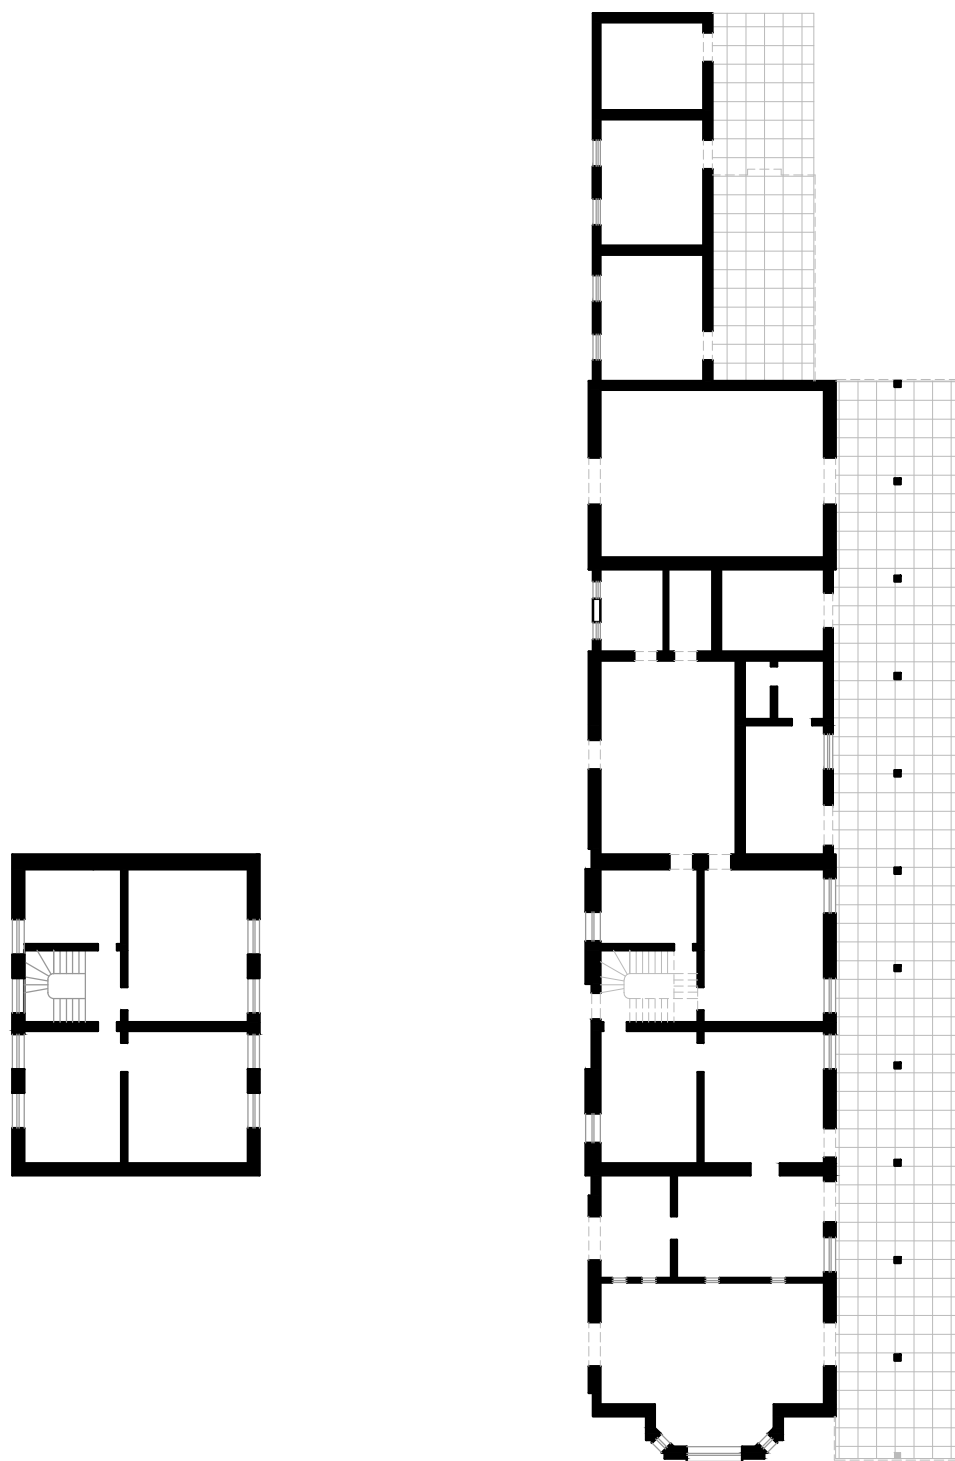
Estación Quilmes, planta y planta alta de la vivienda.
